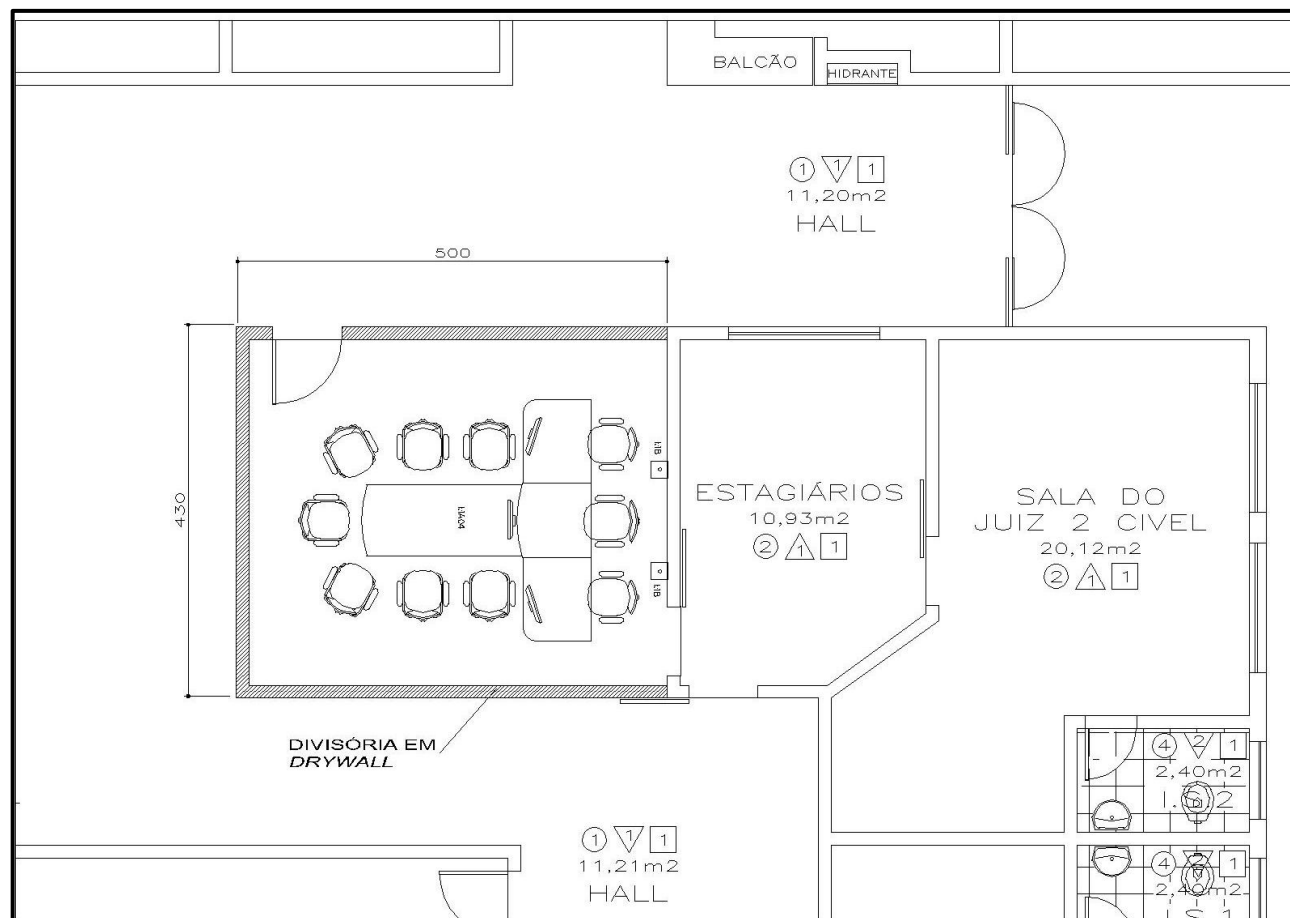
As *hachuras* representam as paredes construídas em *drywall*.
